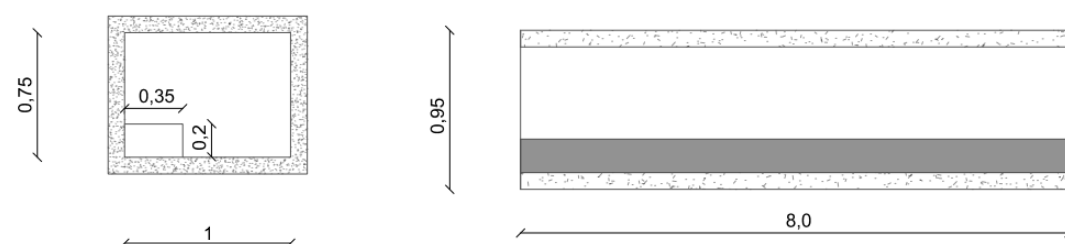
Detalle del acondicionamiento para el paso de fauna de una de las obras de drenaje transversal previstas, con la instalación de una banqueta lateral.
